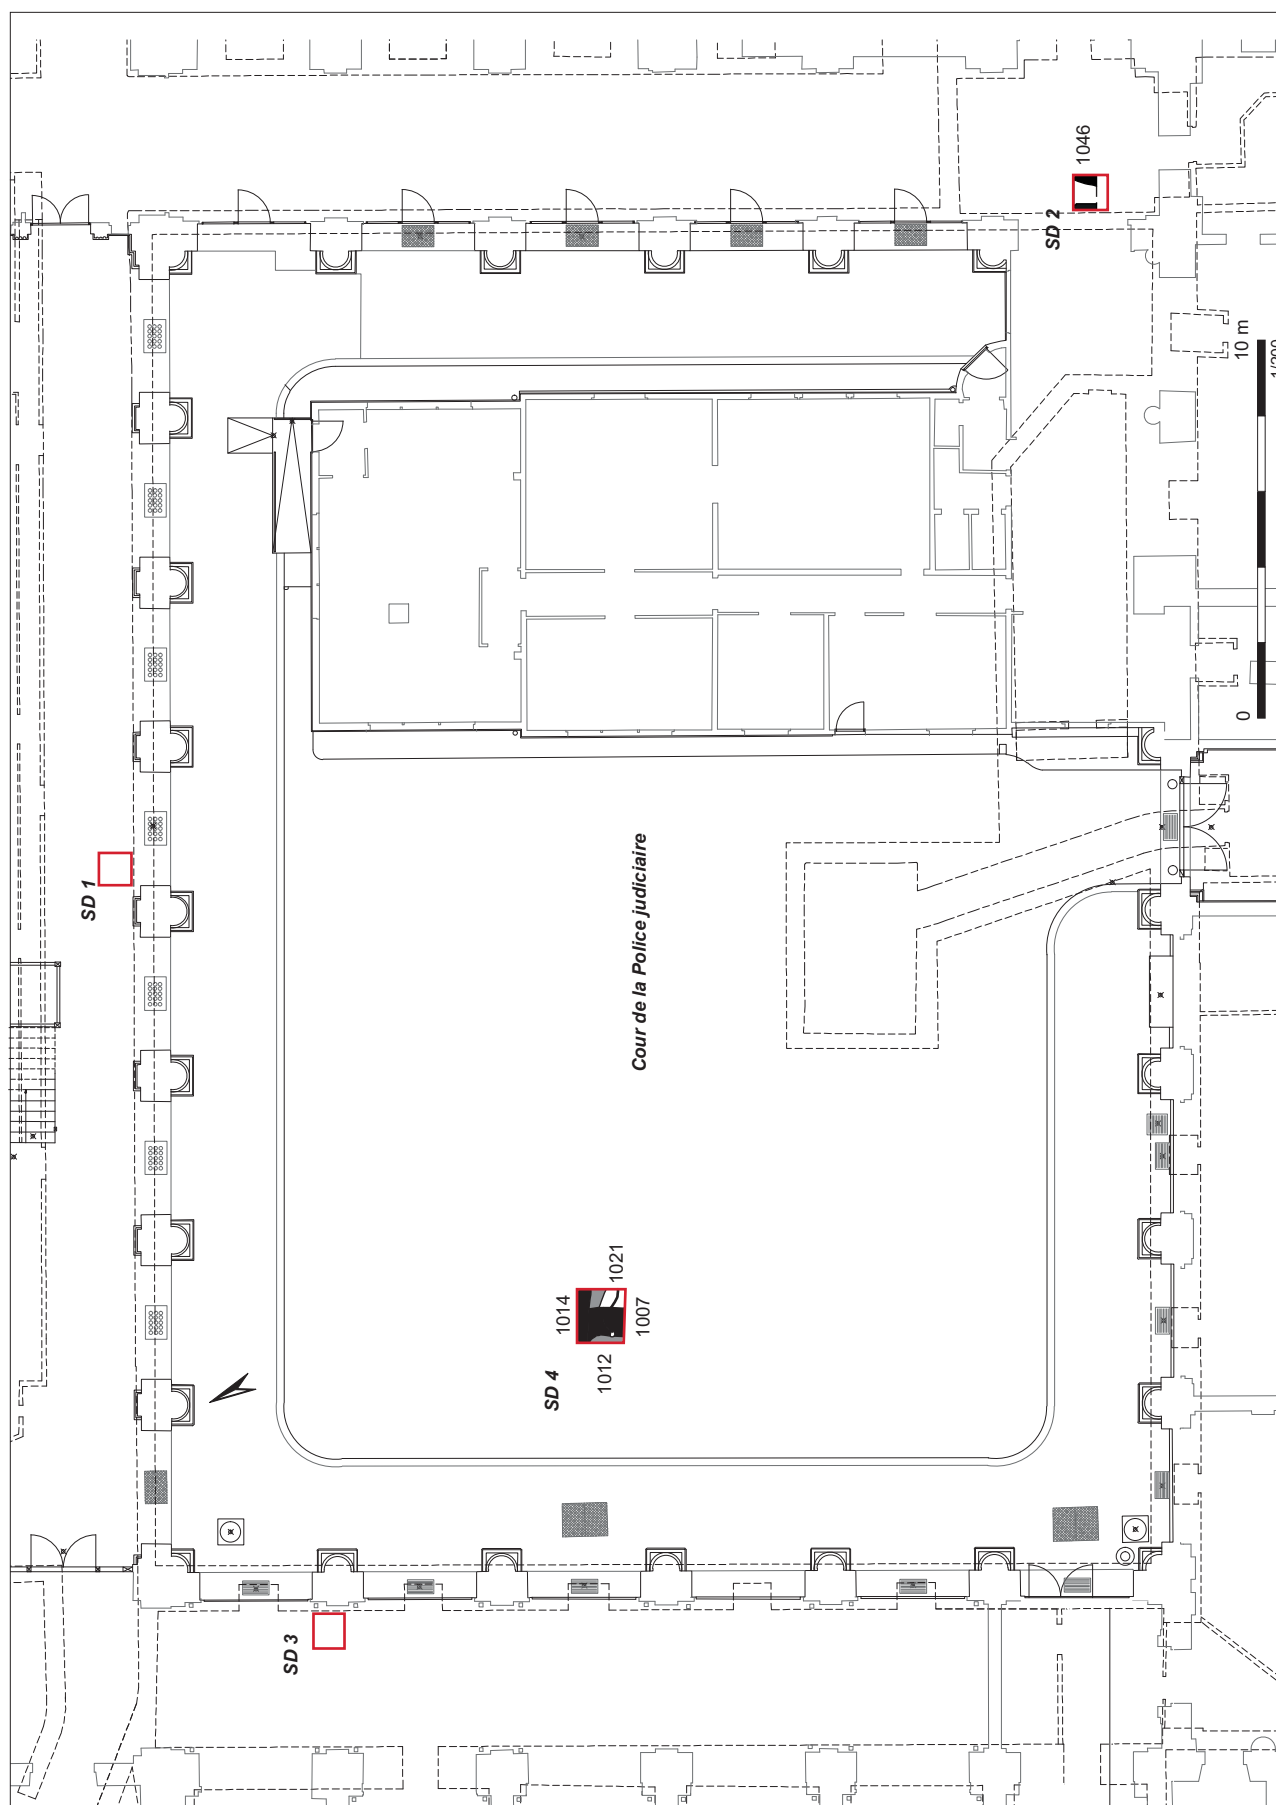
Plan général du diagnostic. Plan : Aménageur. DAO : David Couturier, DHAAP.
